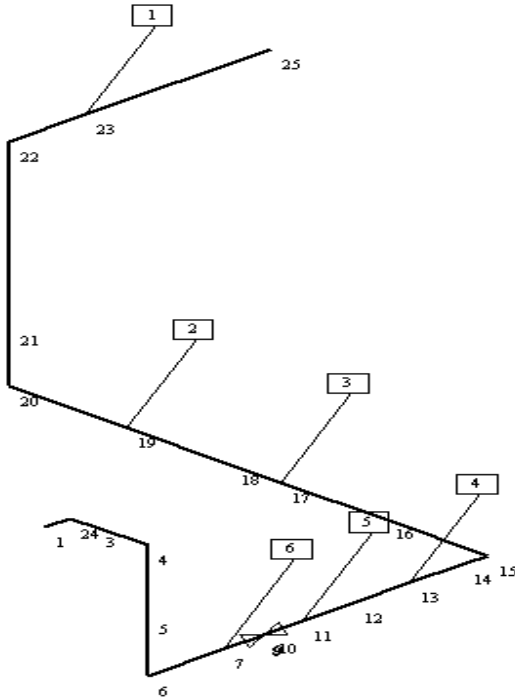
Аксонометрическая схема трубопровода всаса от КЭН-2 Ст. до ПНД-4 (1-25 – расчетные сечения, цифры в прямоугольниках – опоры и подвески)
